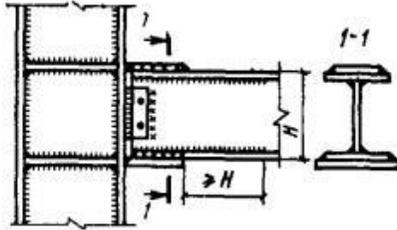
Расположение двухстороннего поясного шва в опорном узле ригеля
